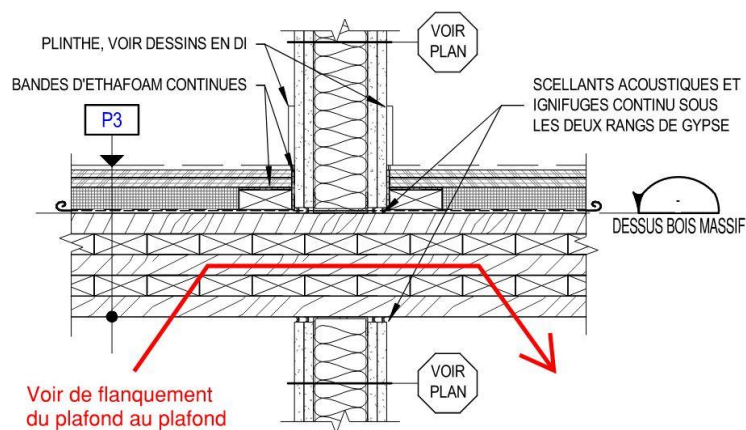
Voie de flanquement du plafond au plafond en condition de panneau de CLT continu sur deux logements
